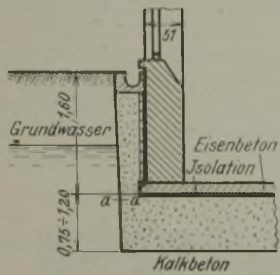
Fundament eines Gebäudes mit Keller bei Grundwasserandrang.
